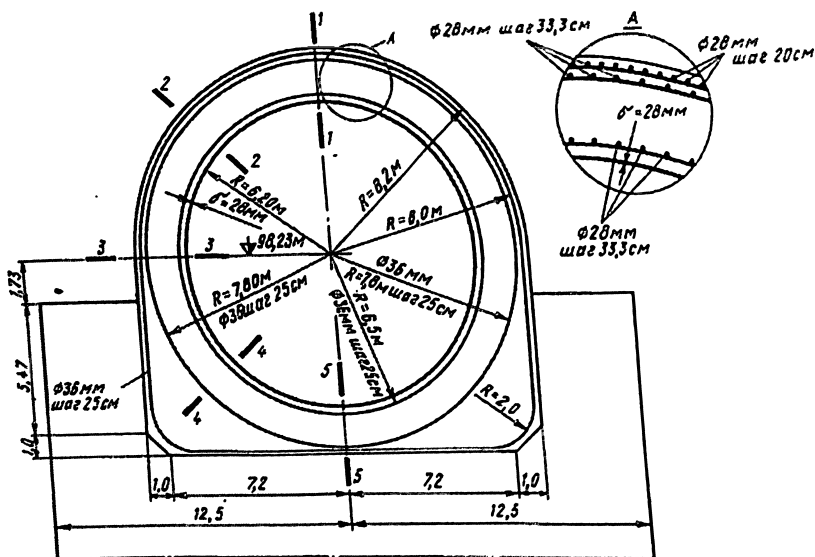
Конструкция водовода в поперечном сечении I-I со схемой армирования
